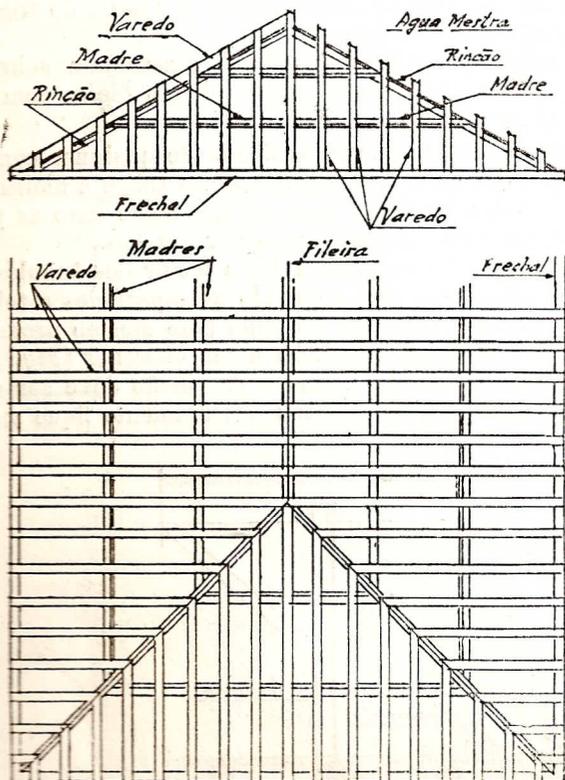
ALÇADO E PLANTA DE UM MADEIRAMENTO DE TRÊS ÁGUAS
